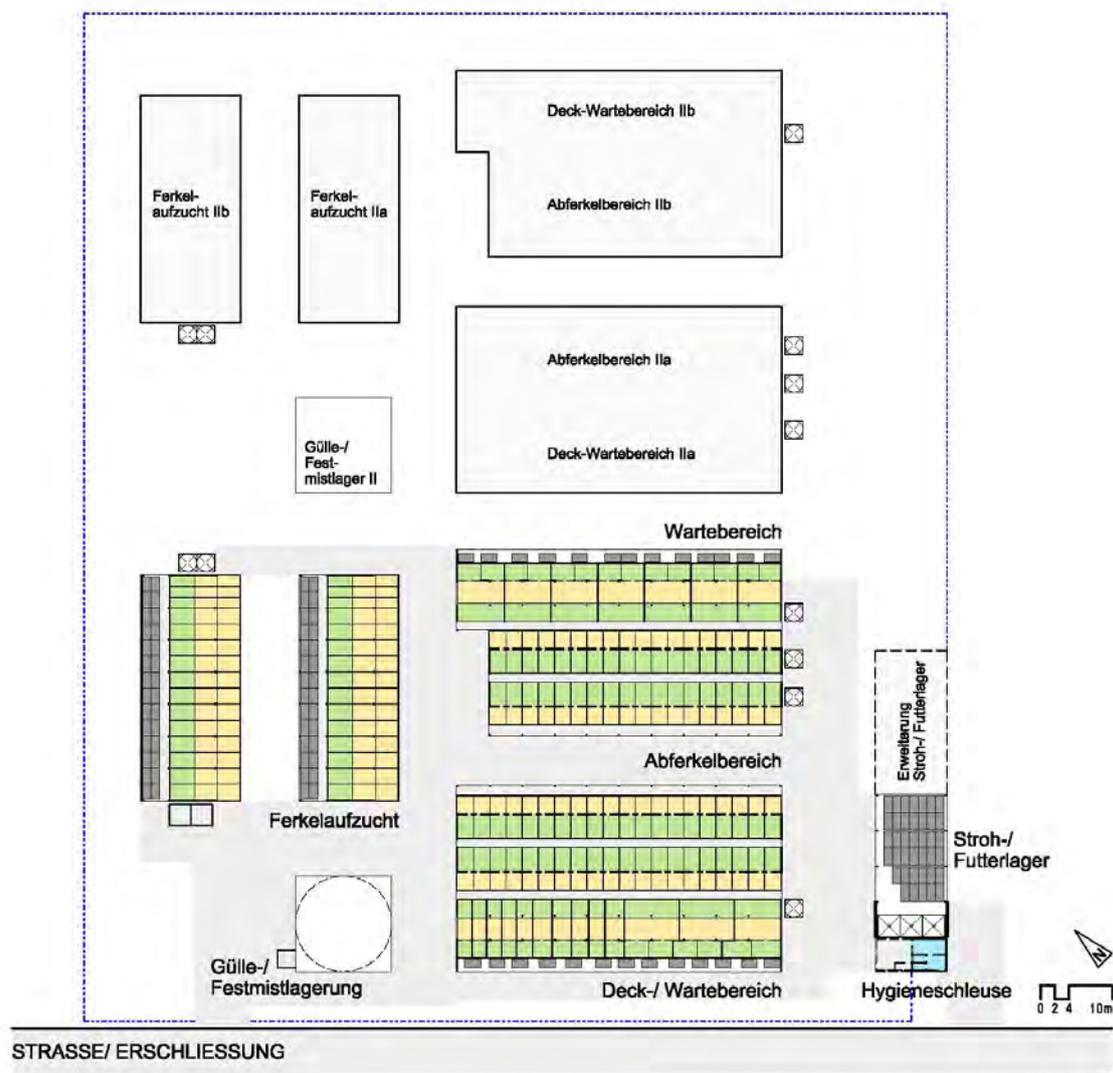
Lageplan Modell II; Wachstumsschritt des Bestandes von 168 auf 336 Sauen
